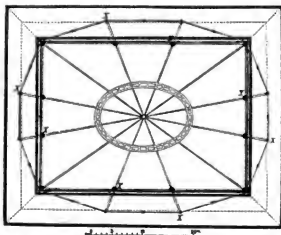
Grundriss der Eisenconstruction des Charles Marcellis.
